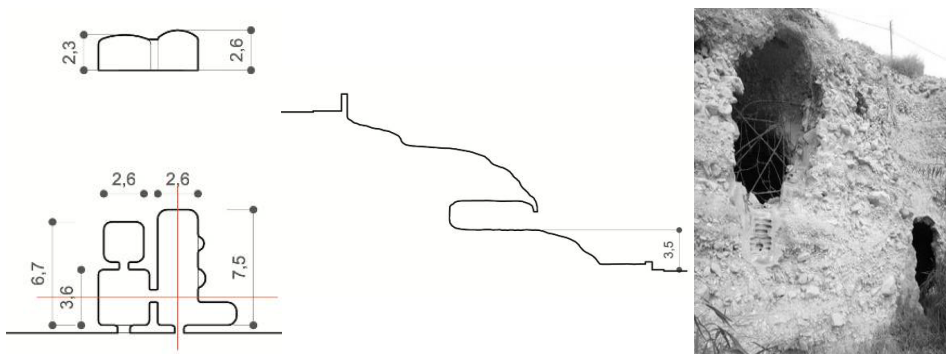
Imagen izqda: Planta y sección transversal de la cueva 1. Fuente: propia. Imagen centro: Sección longitudinal de la cueva 1. Fuente: propia. Imagen dcha: Vista exterior de la cueva 1. Fuente: propia.
